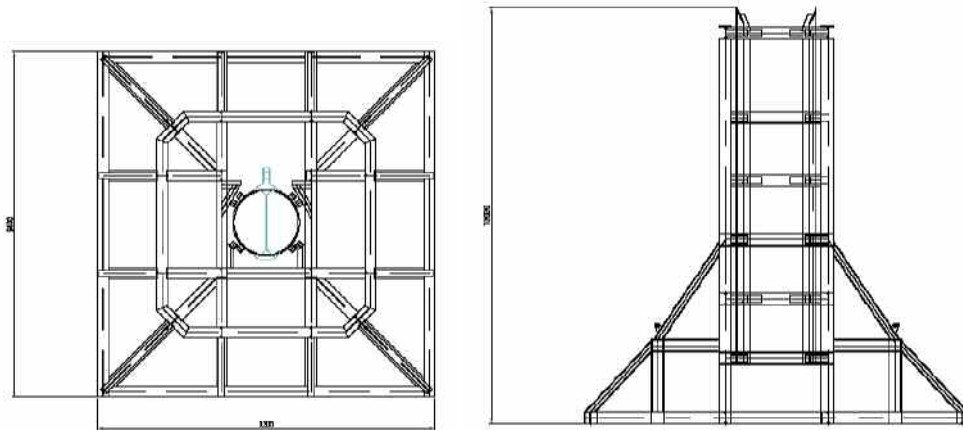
Esempio di strutture di guida per infissione dei palo. Vista in pianta e in sezione.
